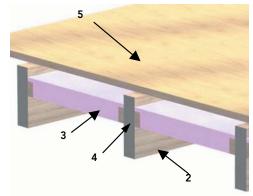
70: Colocación de aislación termo-acústica entre el listoneado de cielo sobre la plancha de yeso cartón, para luego colocar el tablero estructural, arriostrando la estructura de plataforma del entrepiso.
